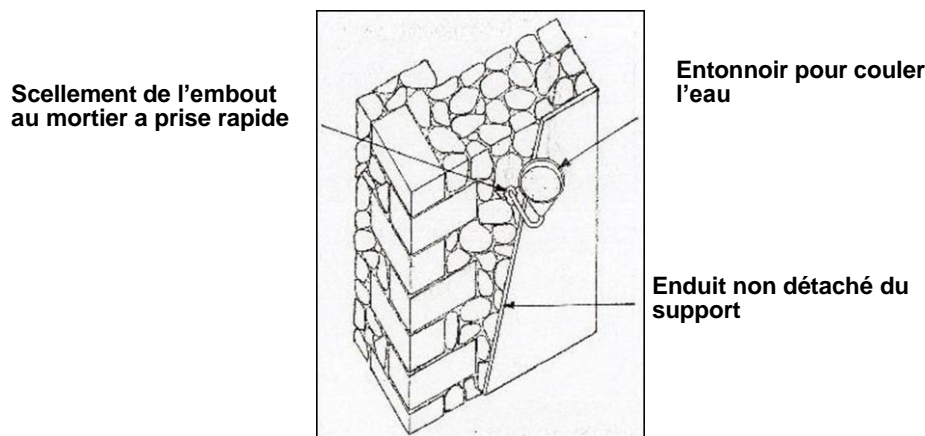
Cimentation d'un mur en pierre par coulée
